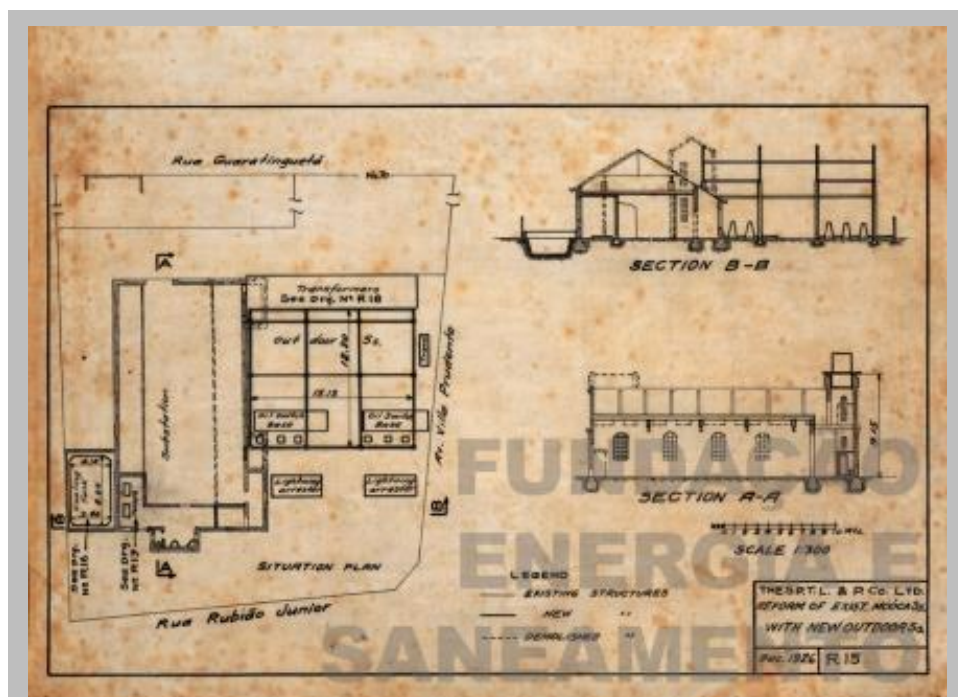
Projeto de ampliação com Planta e corte da primeira subestação da Mooca, 1926. Acervo Fundação Energia e Saneamento, código de identificação: [ELE.PEA.PDC.0272]. São Paulo / SP.
